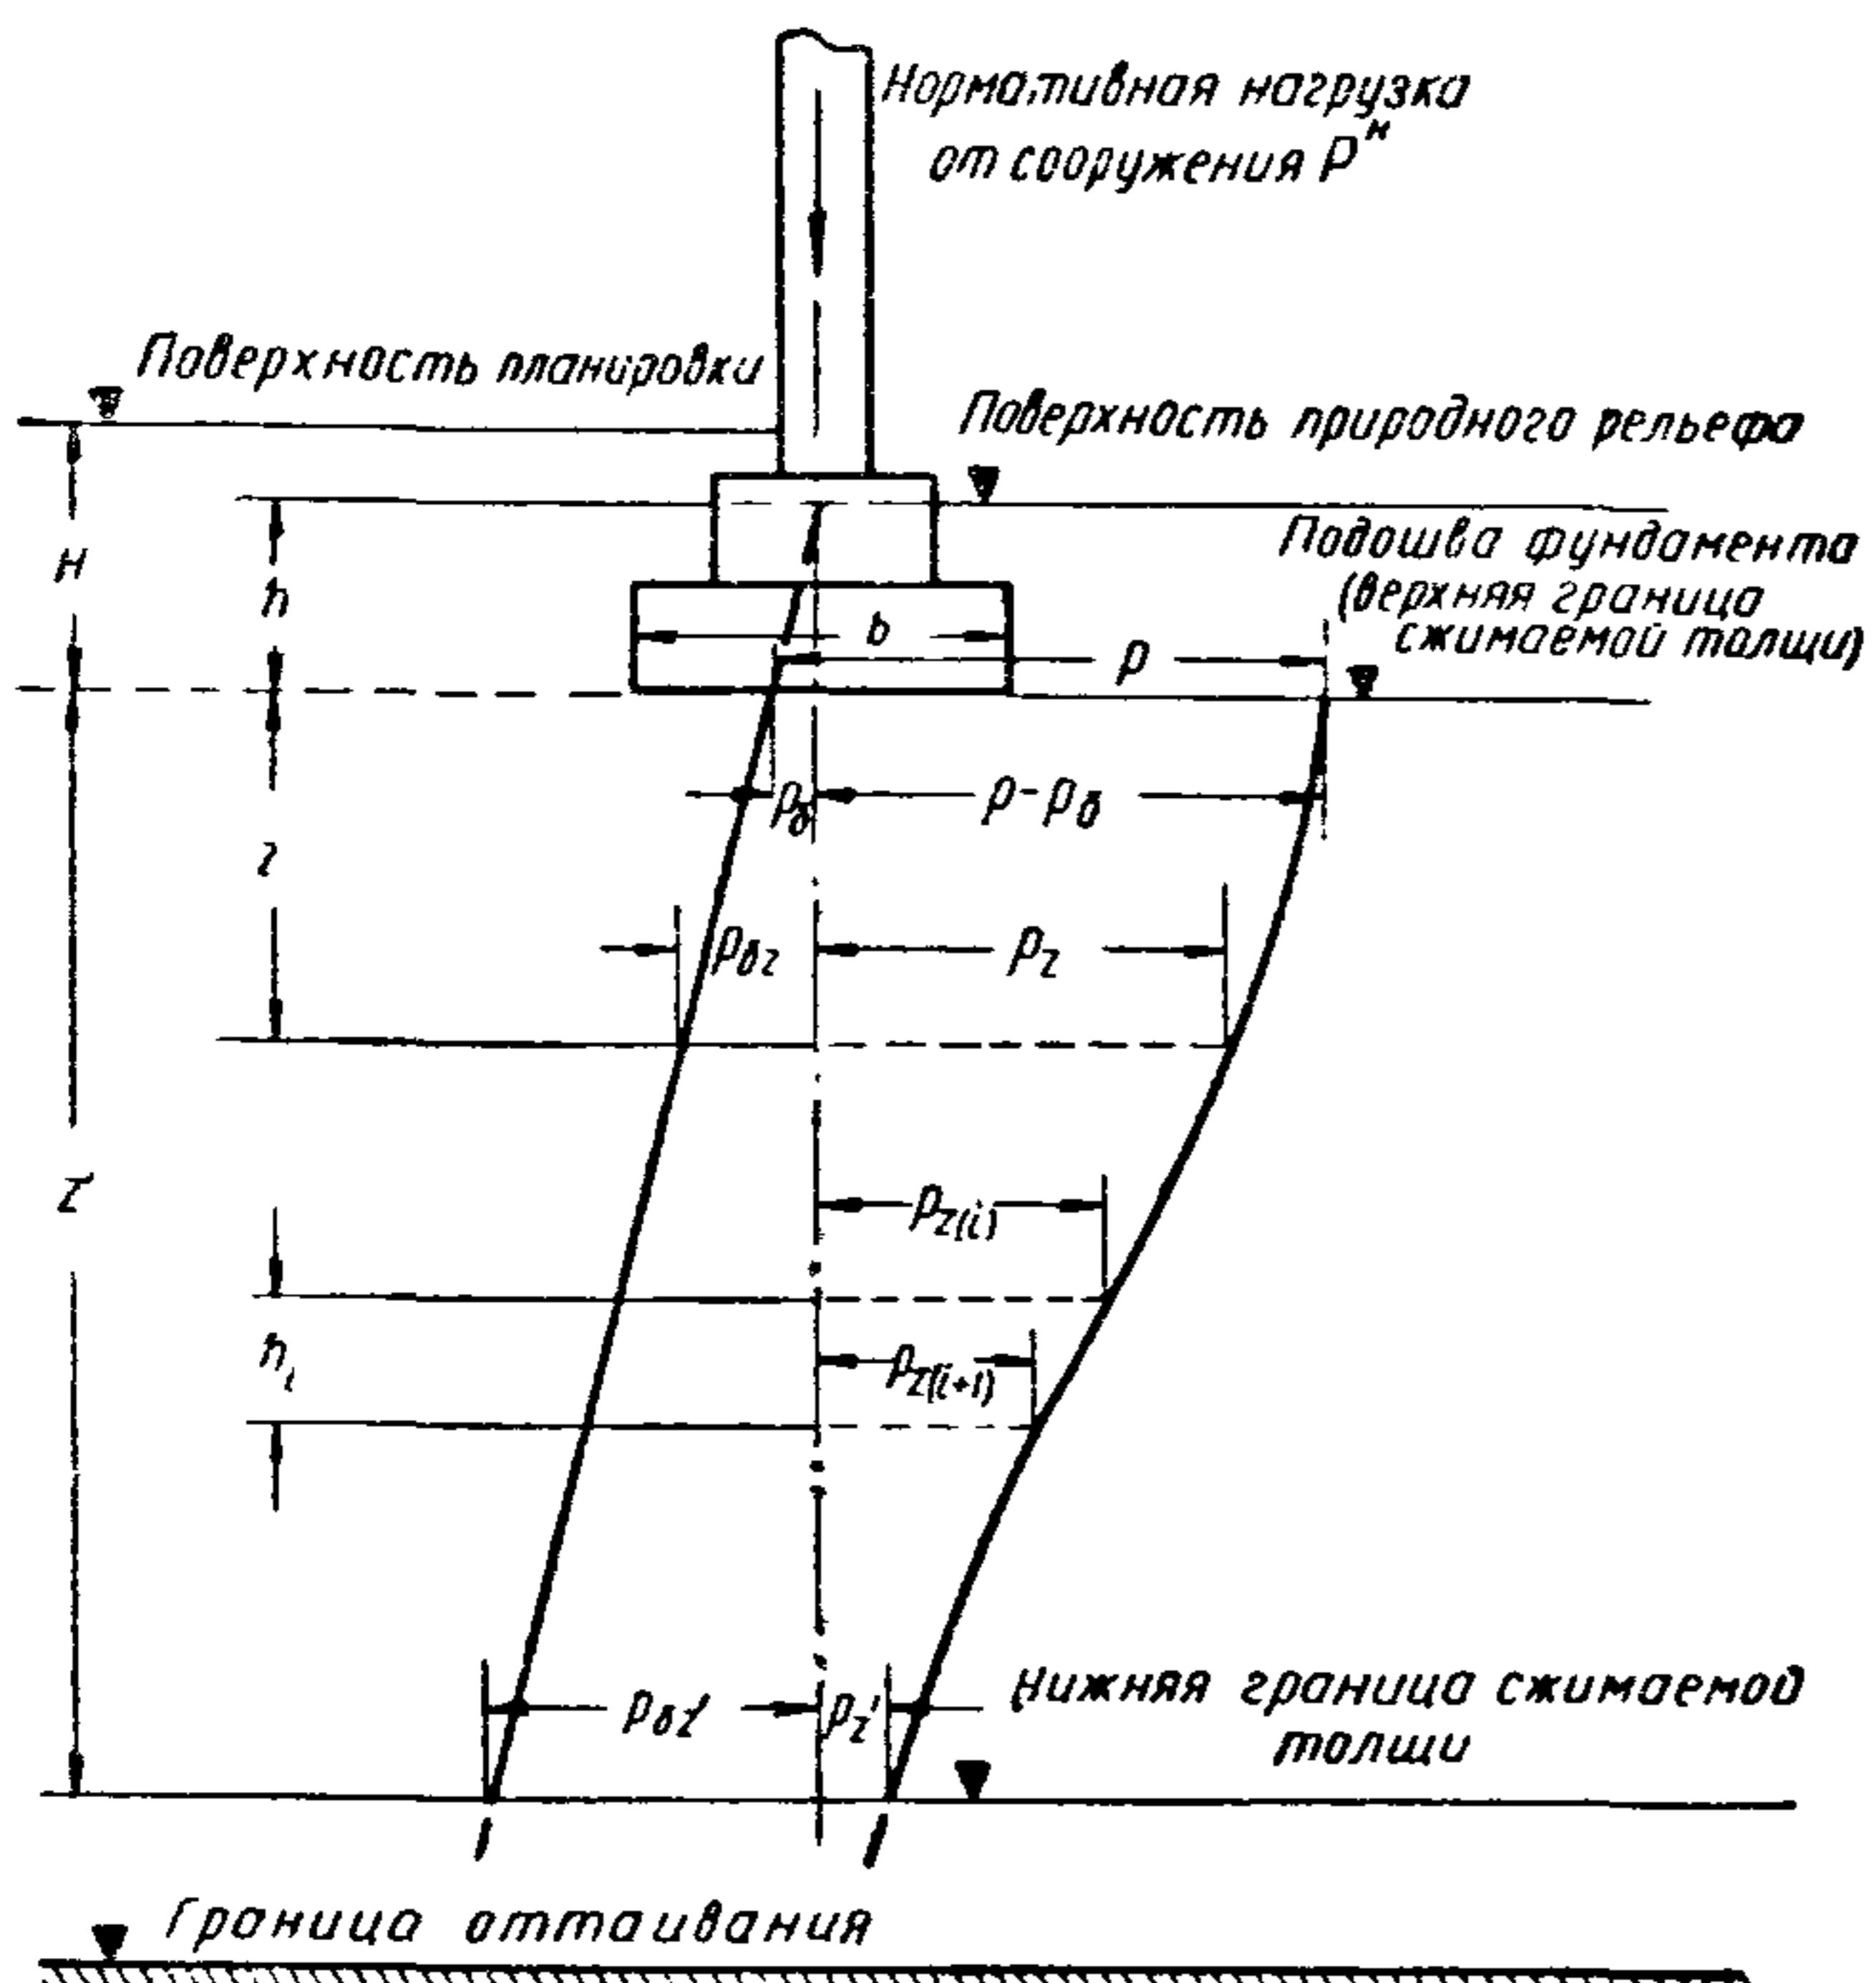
Расчетная схема распределения давления на горизонтальных сечениях в грунте ниже подошвы фундамента
